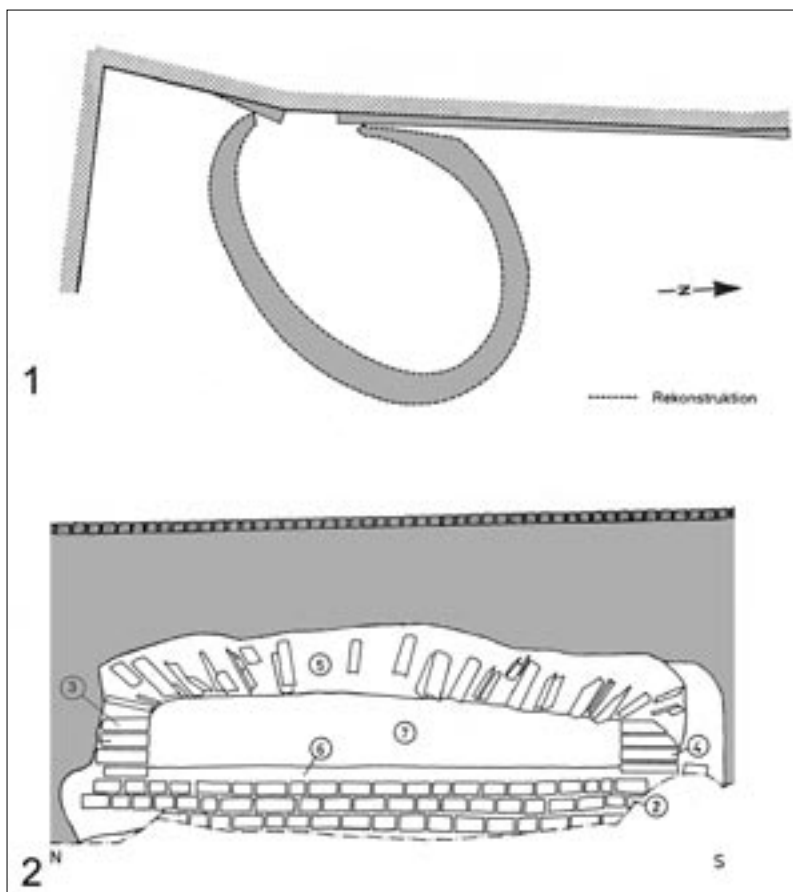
(links): Der flache Ofen aus der Mengstraße 62: 1 Grundriss, 2 Schnitt (nach Meyer/Neugebauer 1982).
